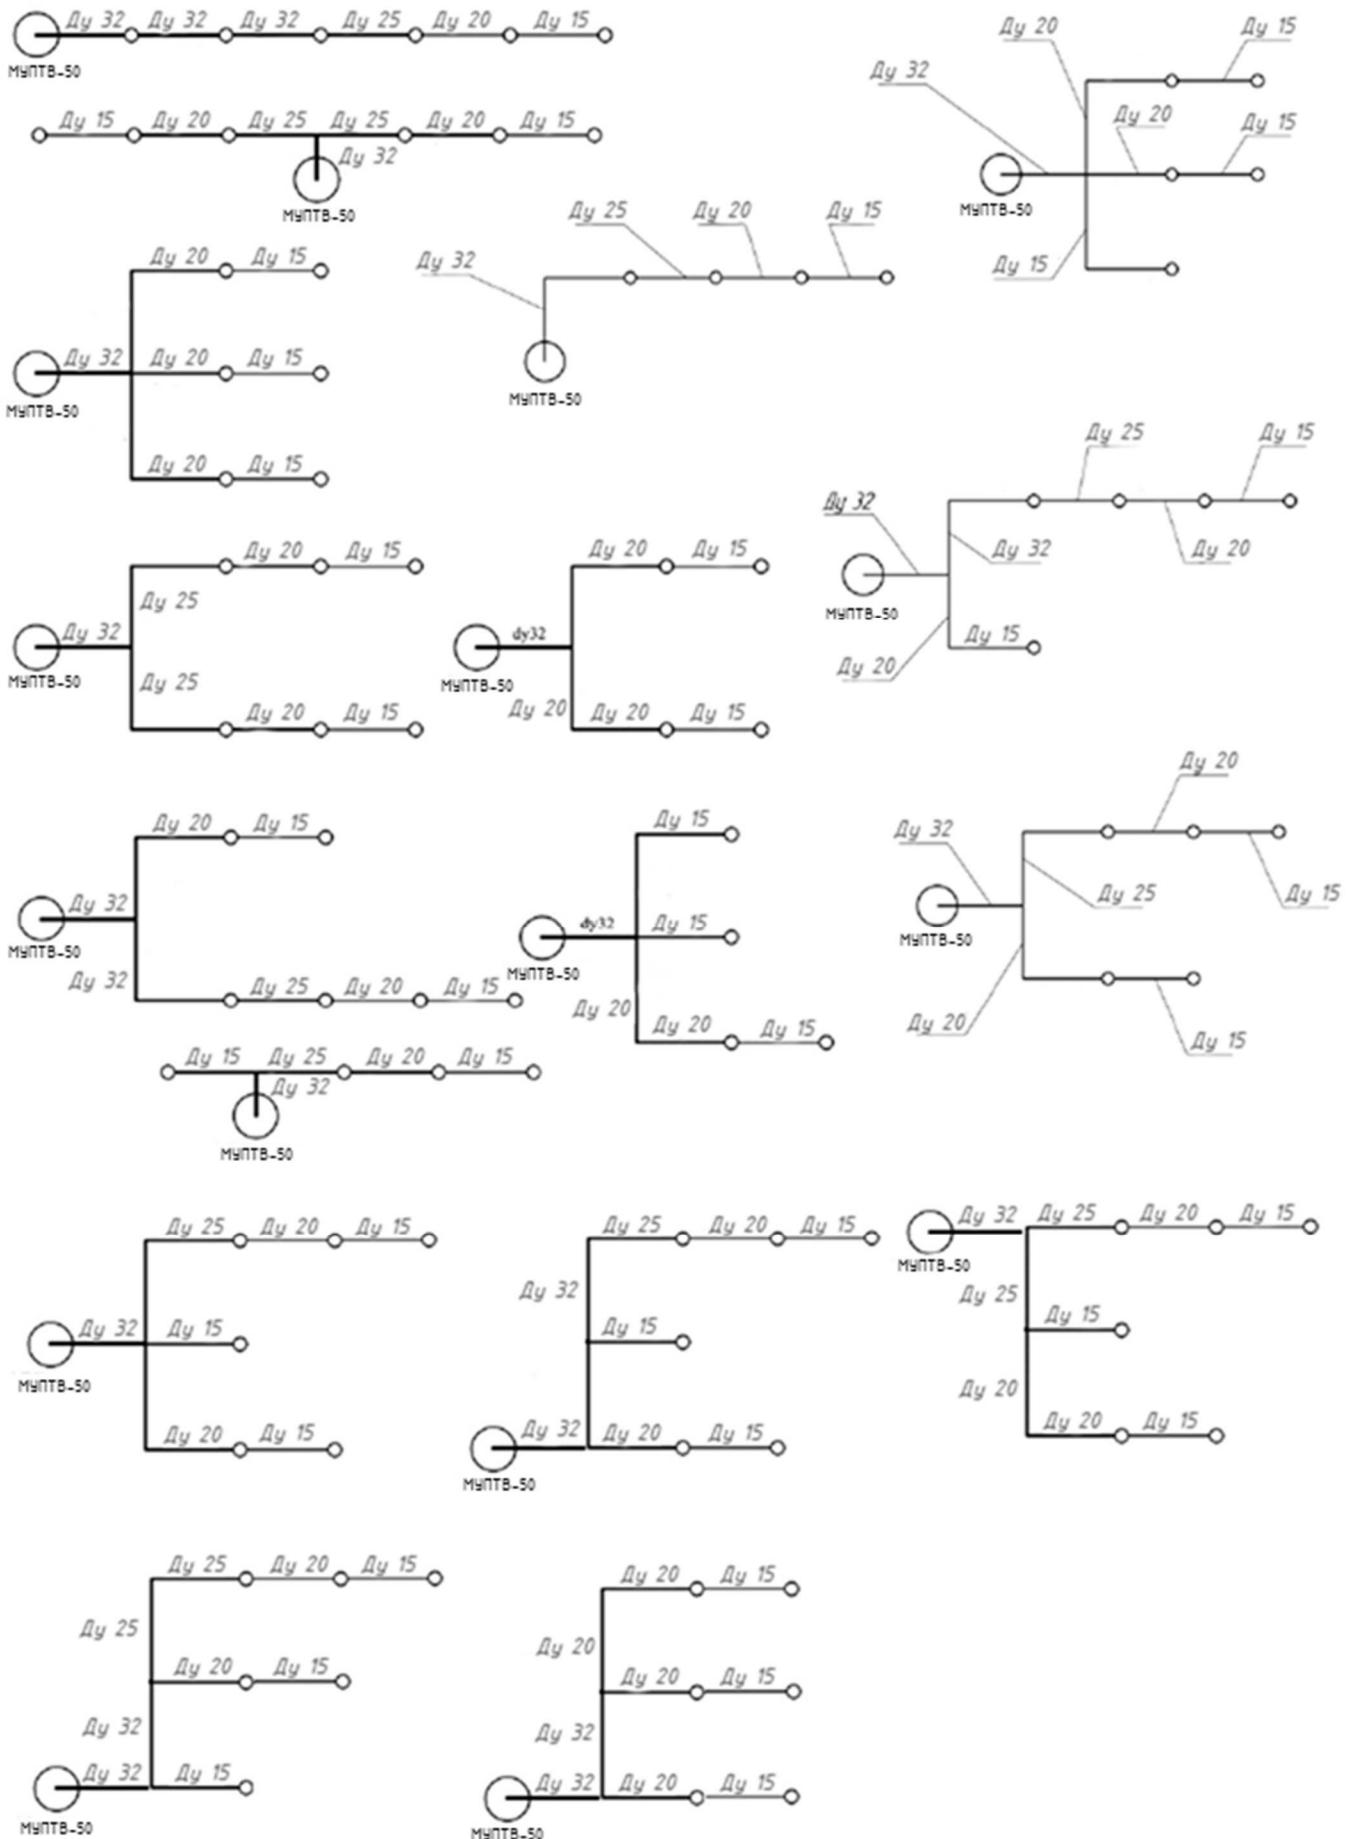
Рекомендуемые схемы проектирования трубопровода
